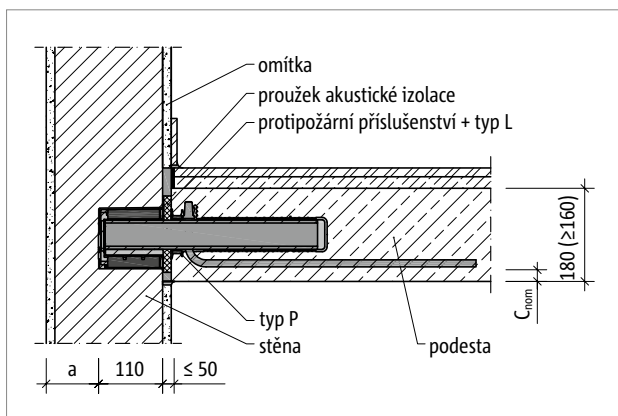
Schöck Tronsole® typ P: Otvor ve stěně u prefabrikované konstrukce
